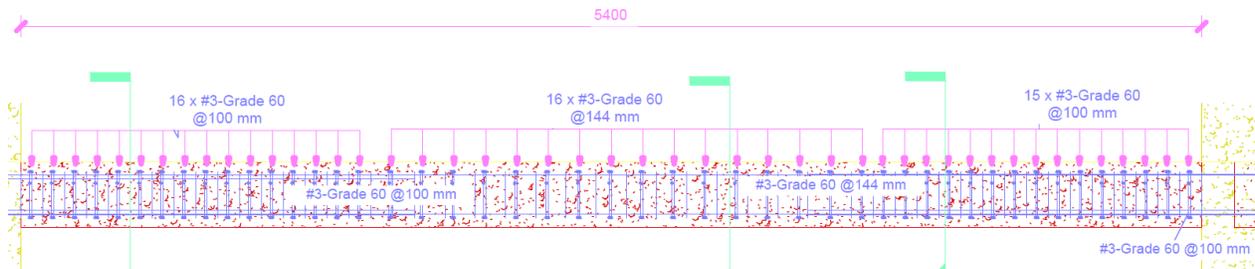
Detalle de traslape y anclaje de Viga asísmica con empalmes mecánicos
